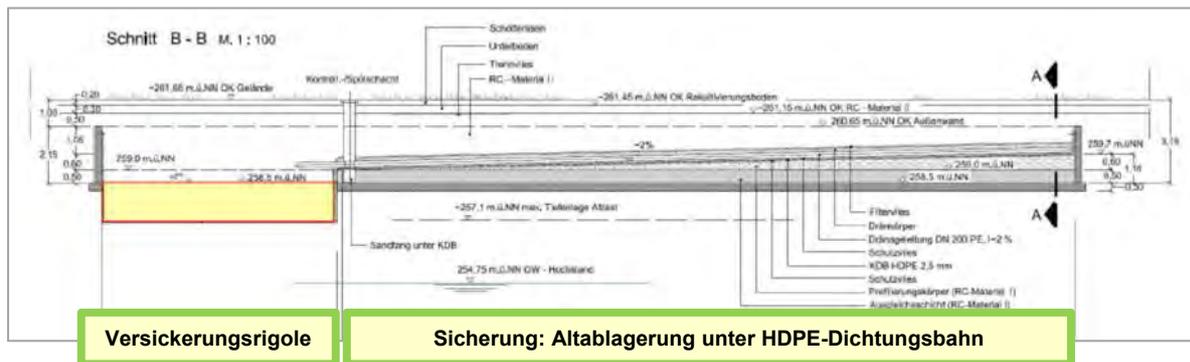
Sicherung AA 9027 (Untergeschoß Kantine) mit Flächenentwässerung / Rigolenversickerung (gelb) außerhalb unter der Altablagerung (Ausführungsplan ARCADIS)
